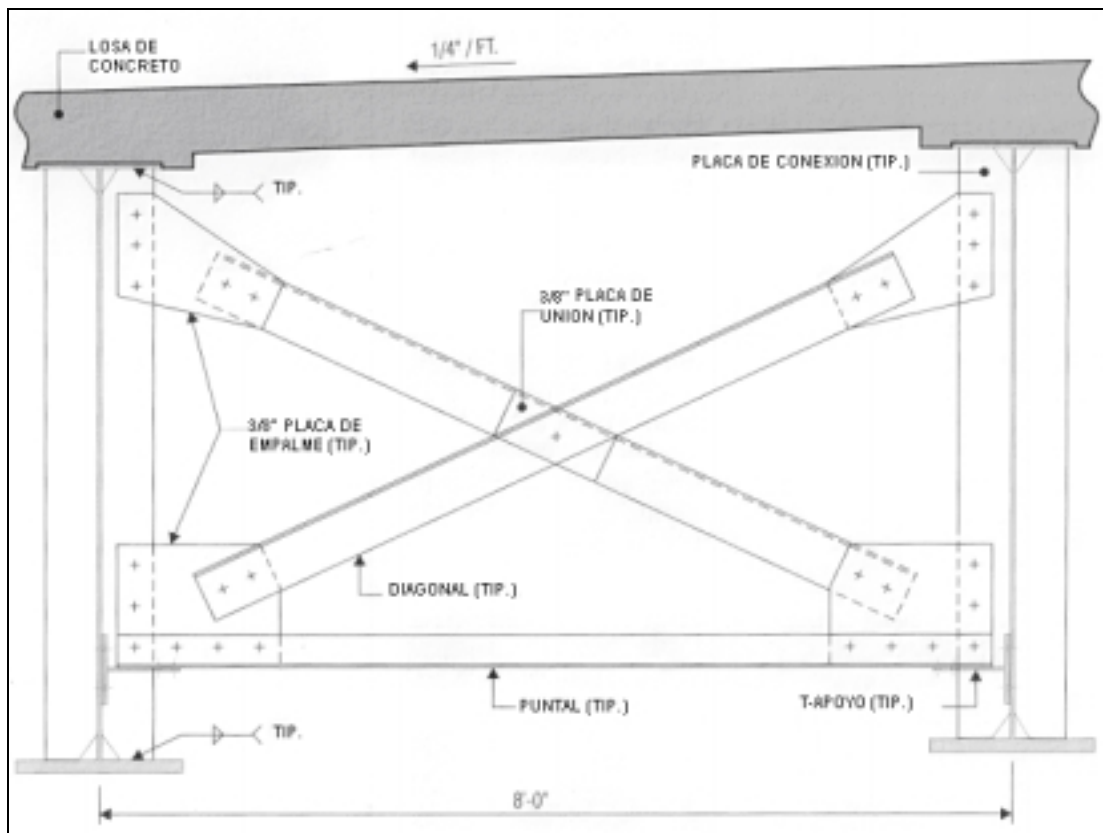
Arriostamiento tipo marco–transversal para una superestructura de traveses armados. (Tomada de Standard Plans for Highway Bridges, vol.II, Structural Steel Superstructures, FHWA, Ref 3.9.)
